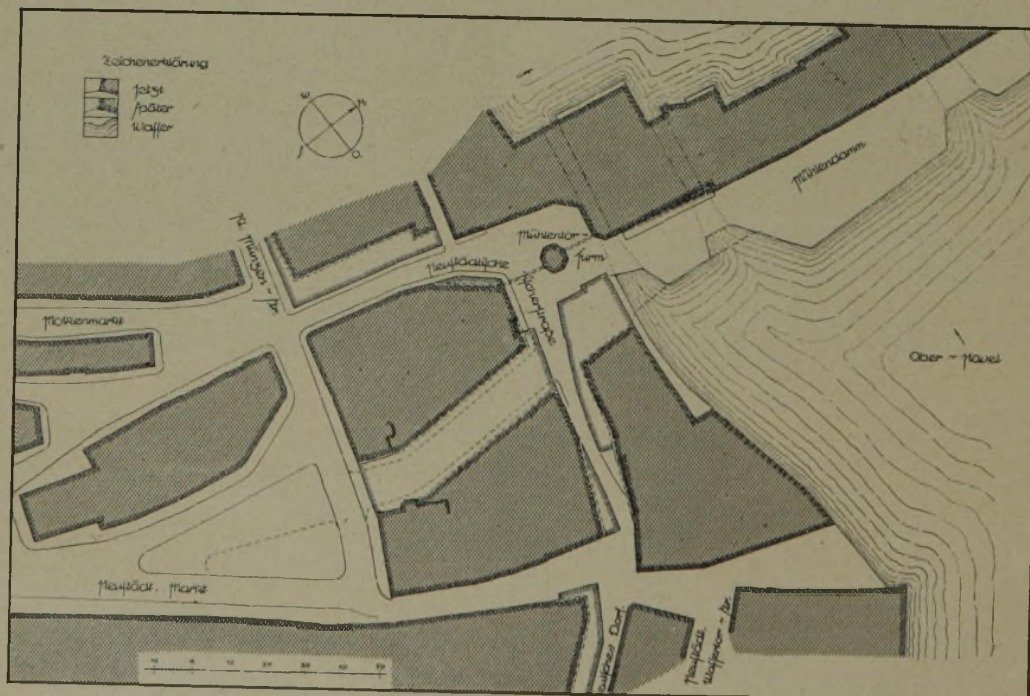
Mühlentorturm. Lageplan 1 : 2000.
